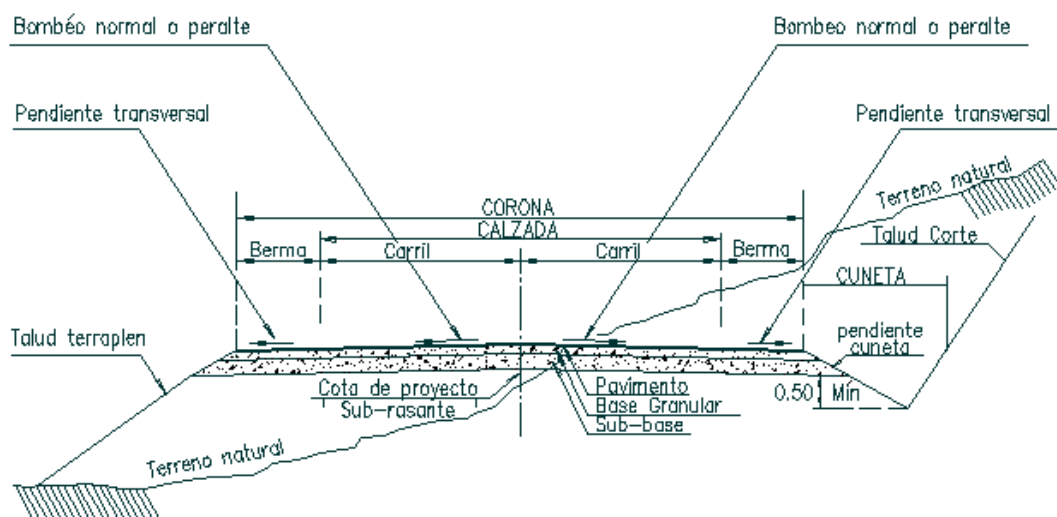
Esquematación de los elementos que constituyen la sección trasversal de una carretera.
